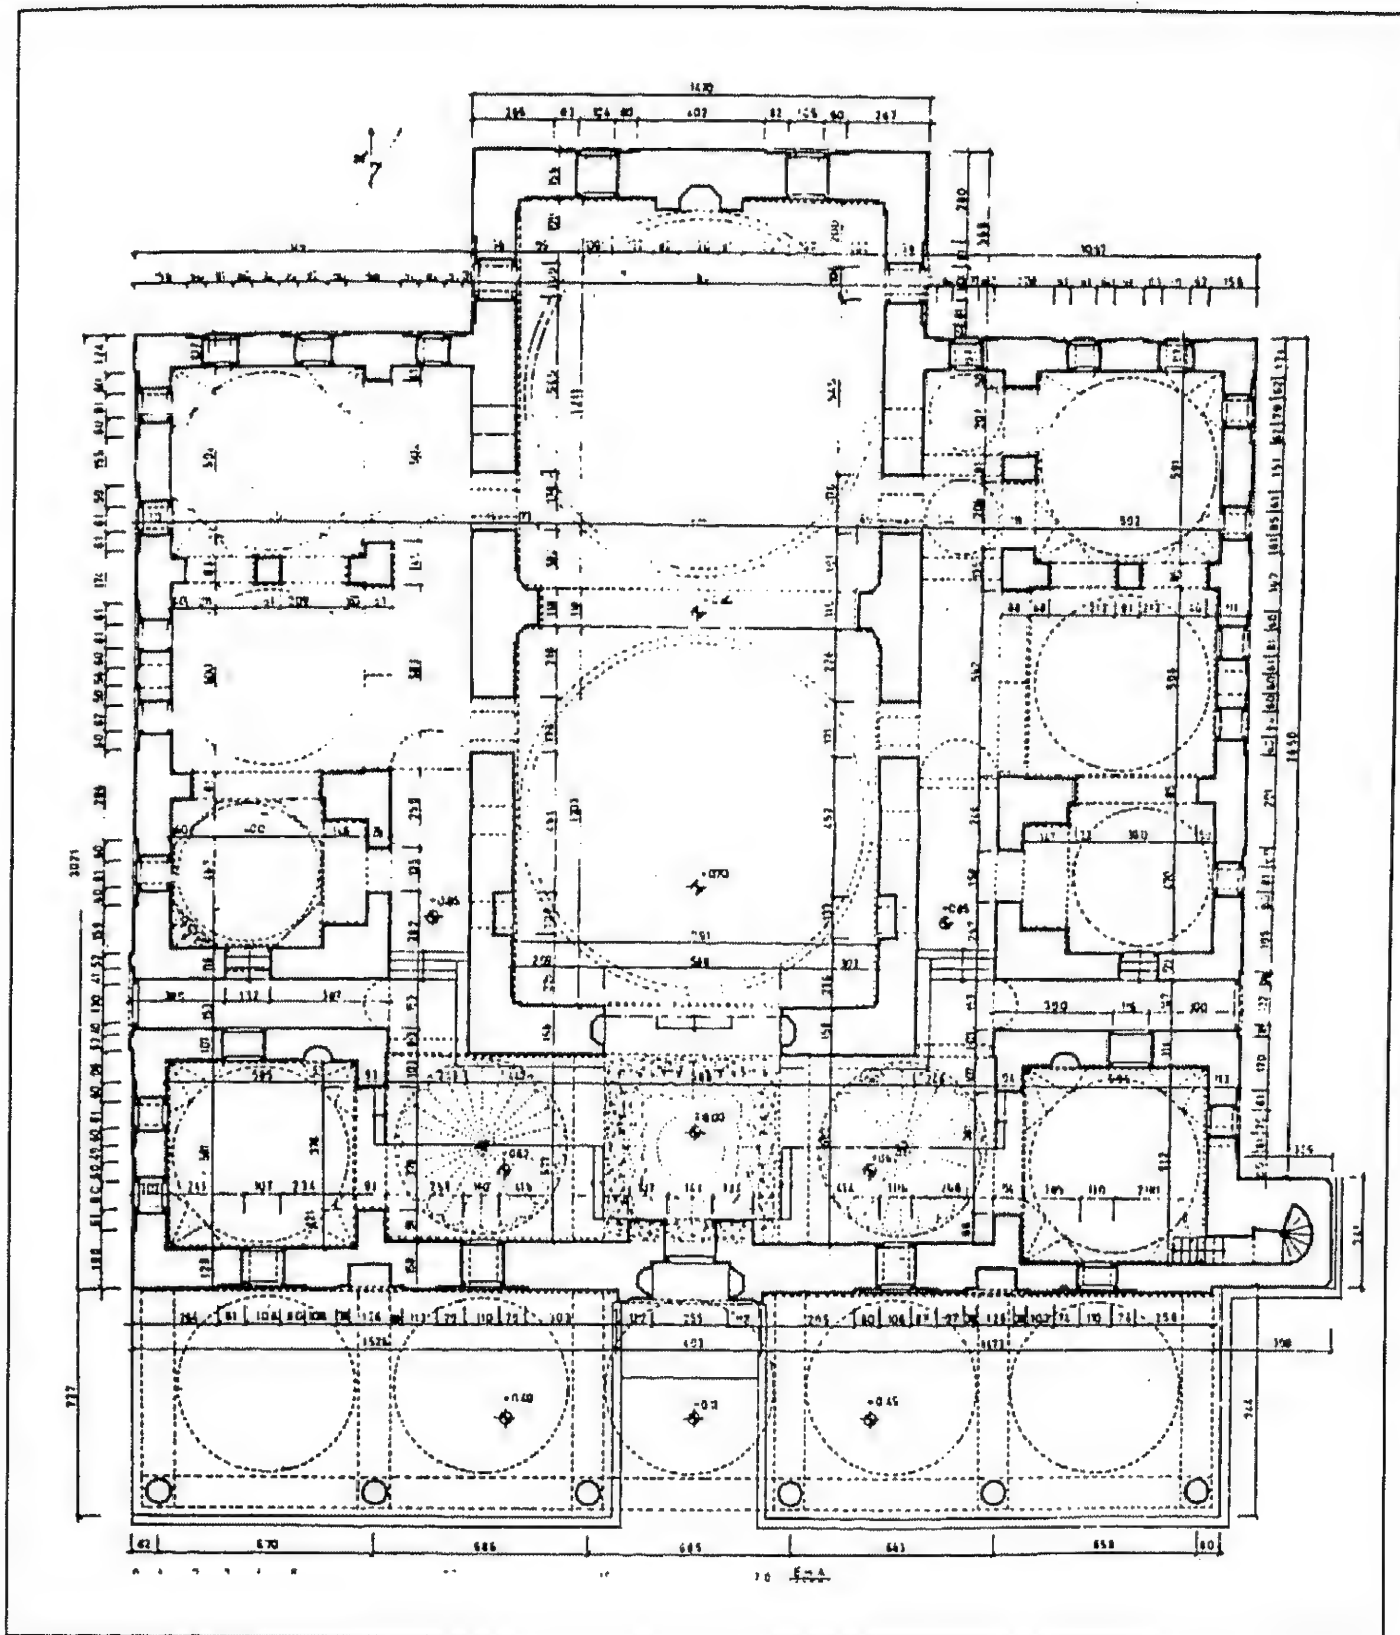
مسقط أفقي لمسجد عيسى بك في أسكوب (عن: إيفردى).
